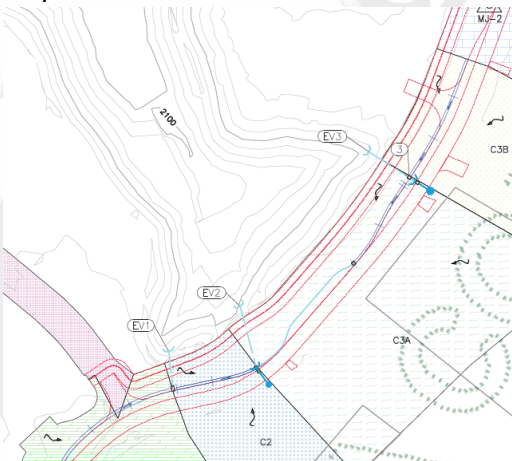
Estructuras de descarga EV1, EV2 y EV3 para construcción de ciclorrutas
